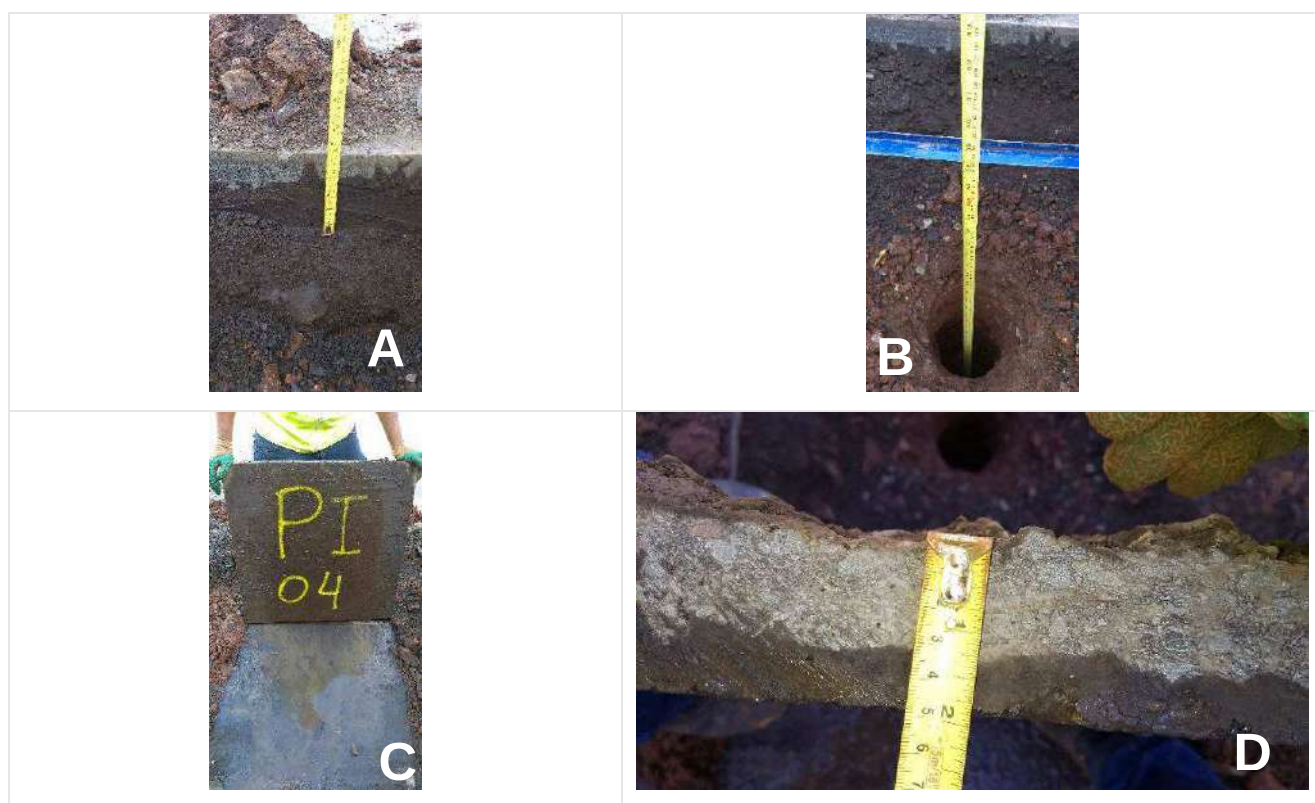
Rua Morenitas - Poço de Inspeção (Cava de Inspeção) – PI-04
